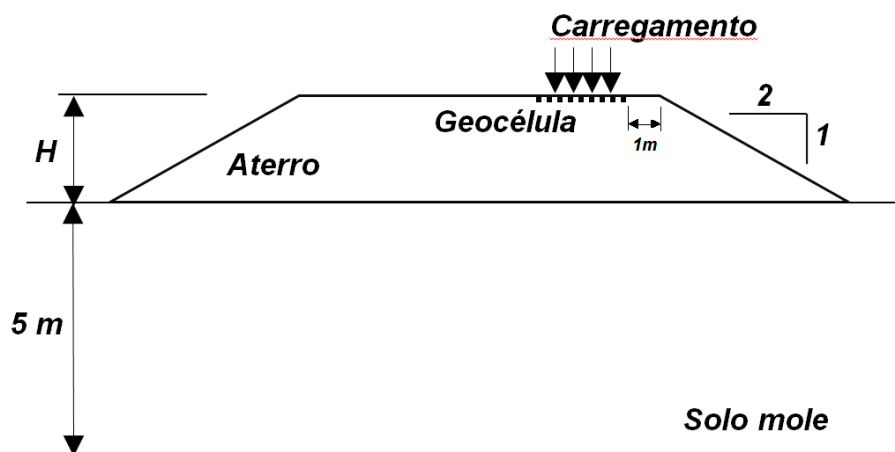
Seção transversal esquemática para avaliação da aplicação do reforço sob carregamento em aterros sobre solos moles
